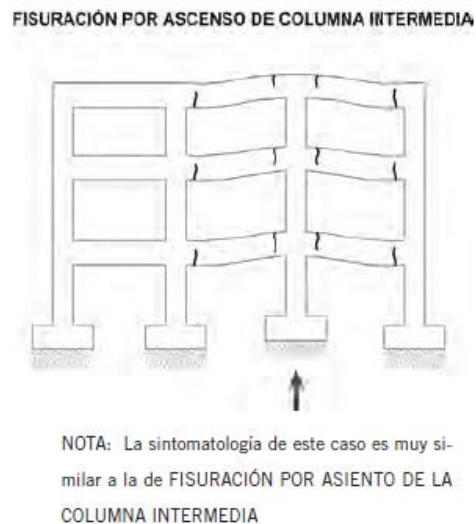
Fisuración por ascenso de columna intermedia
